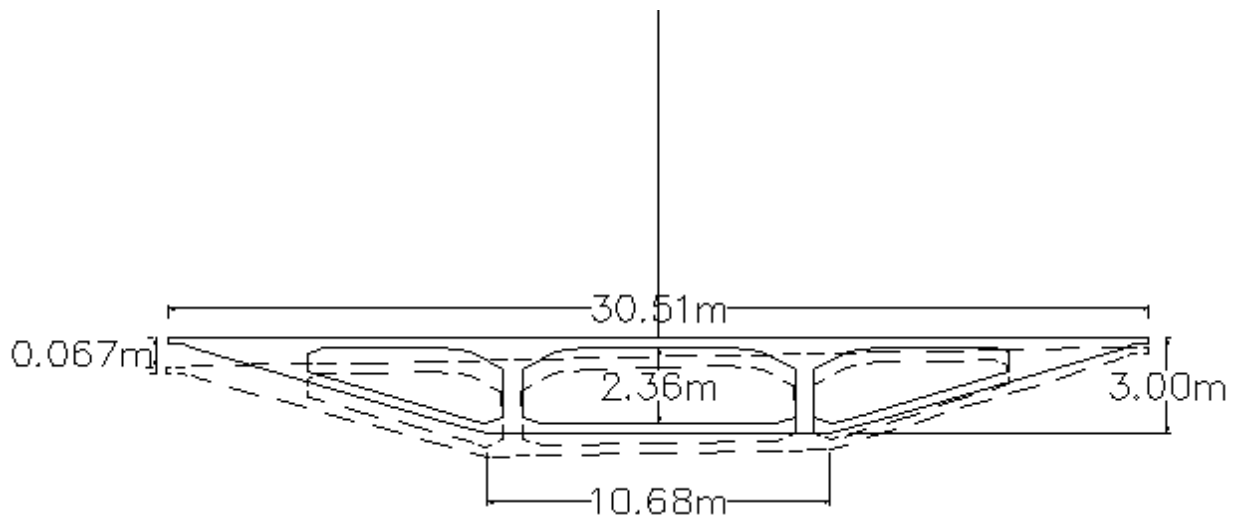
Sección transversal Tricelular-Central Deformada. Fuente: Autores
